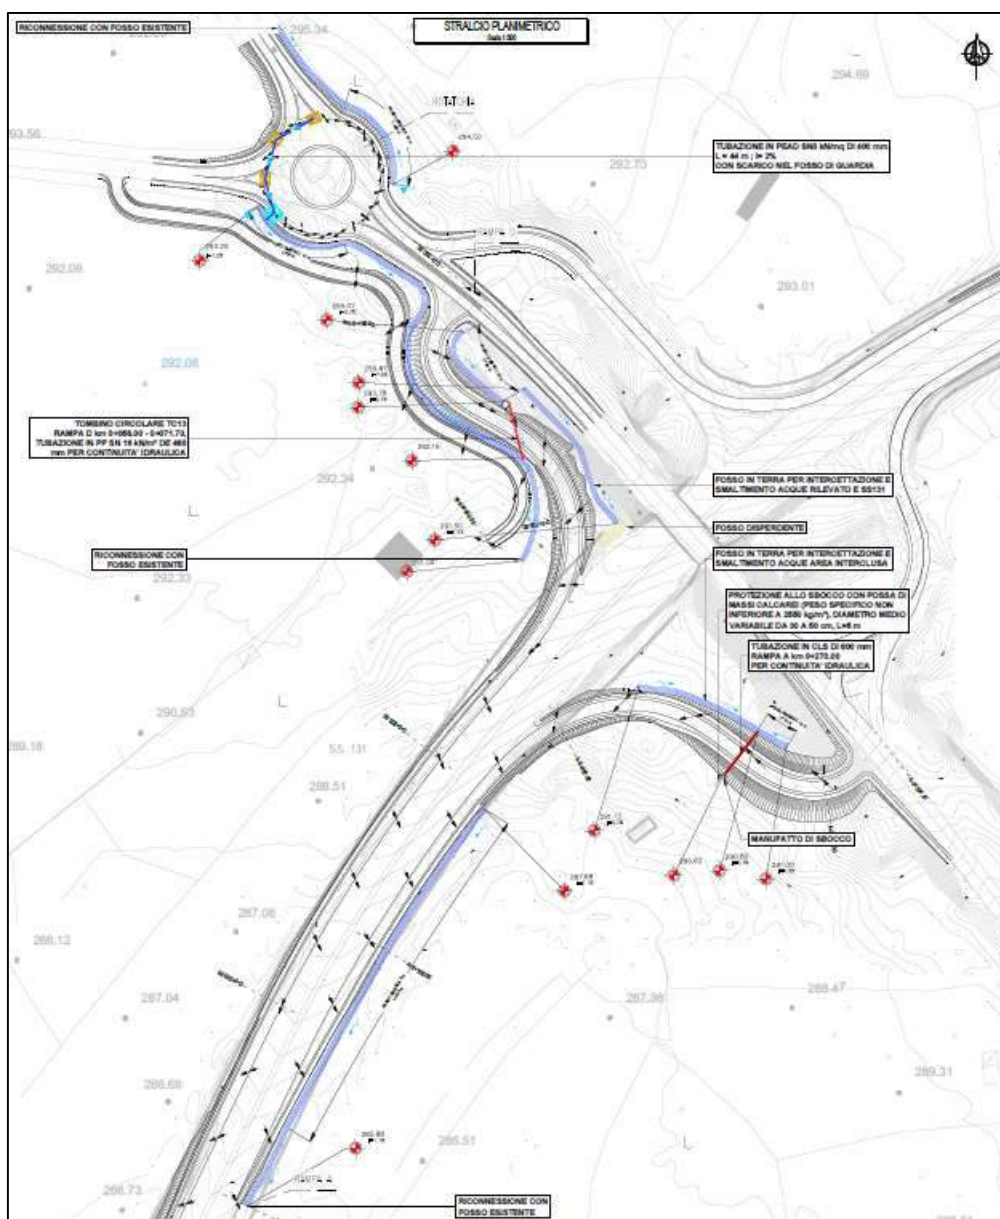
Stralcio planimetrico intervento V04-Svincolo di Paulilatino al km 119+000
